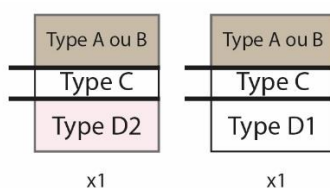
Superpositions des enduits de type B non peints, de type C et de type D
